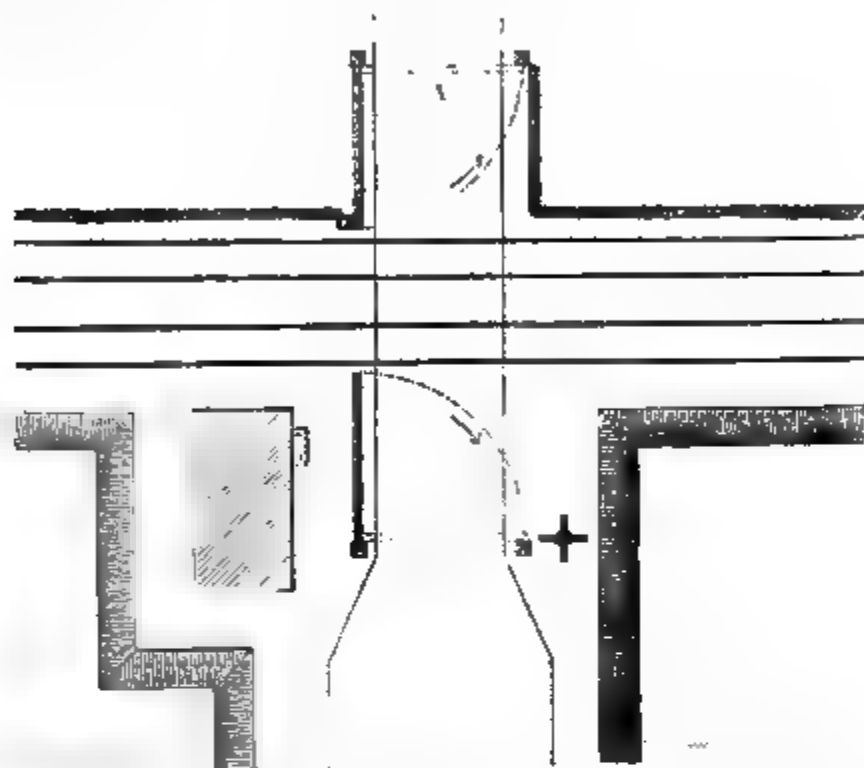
Plan d'ensemble d'un passage à niveau.
